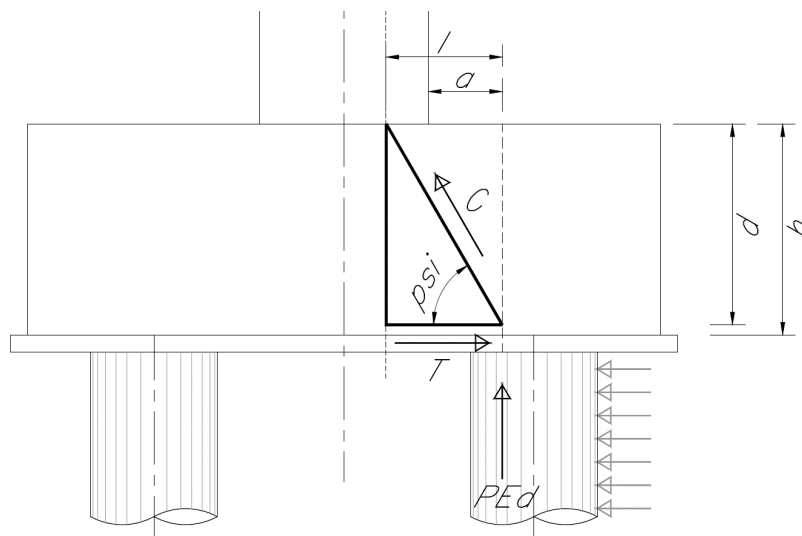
Tirante puntone - Biella compressa di calcestruzzo C e tirante di armatura T
